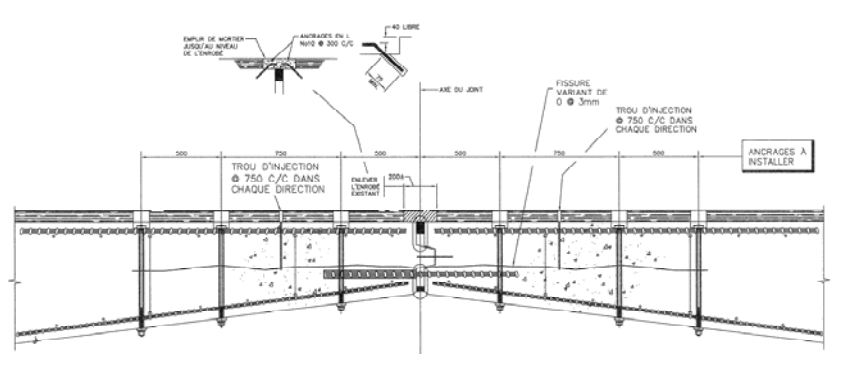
Travaux d'ancrage des porte-à-faux au pont Sud
